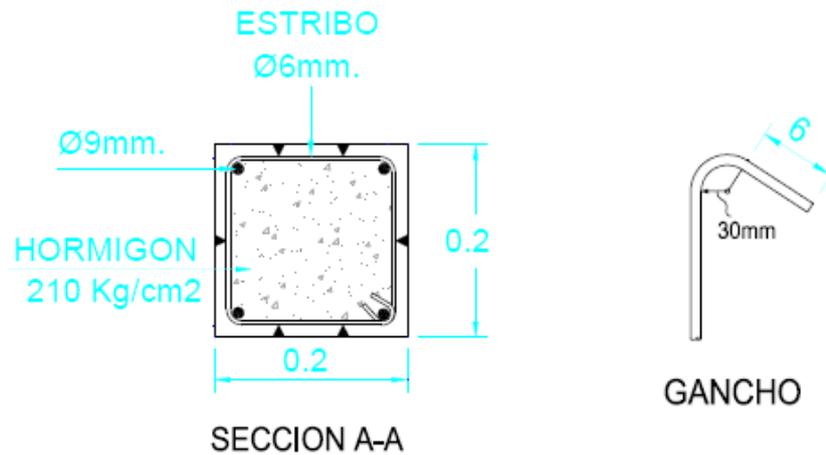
Detalle corte en planta de columna tipo y gancho del estribo.
